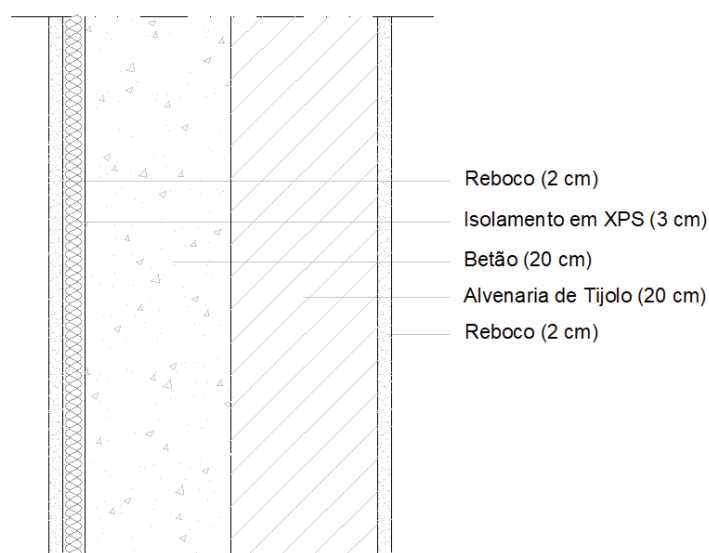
Pormenor construtivo da parede exterior tipo III
